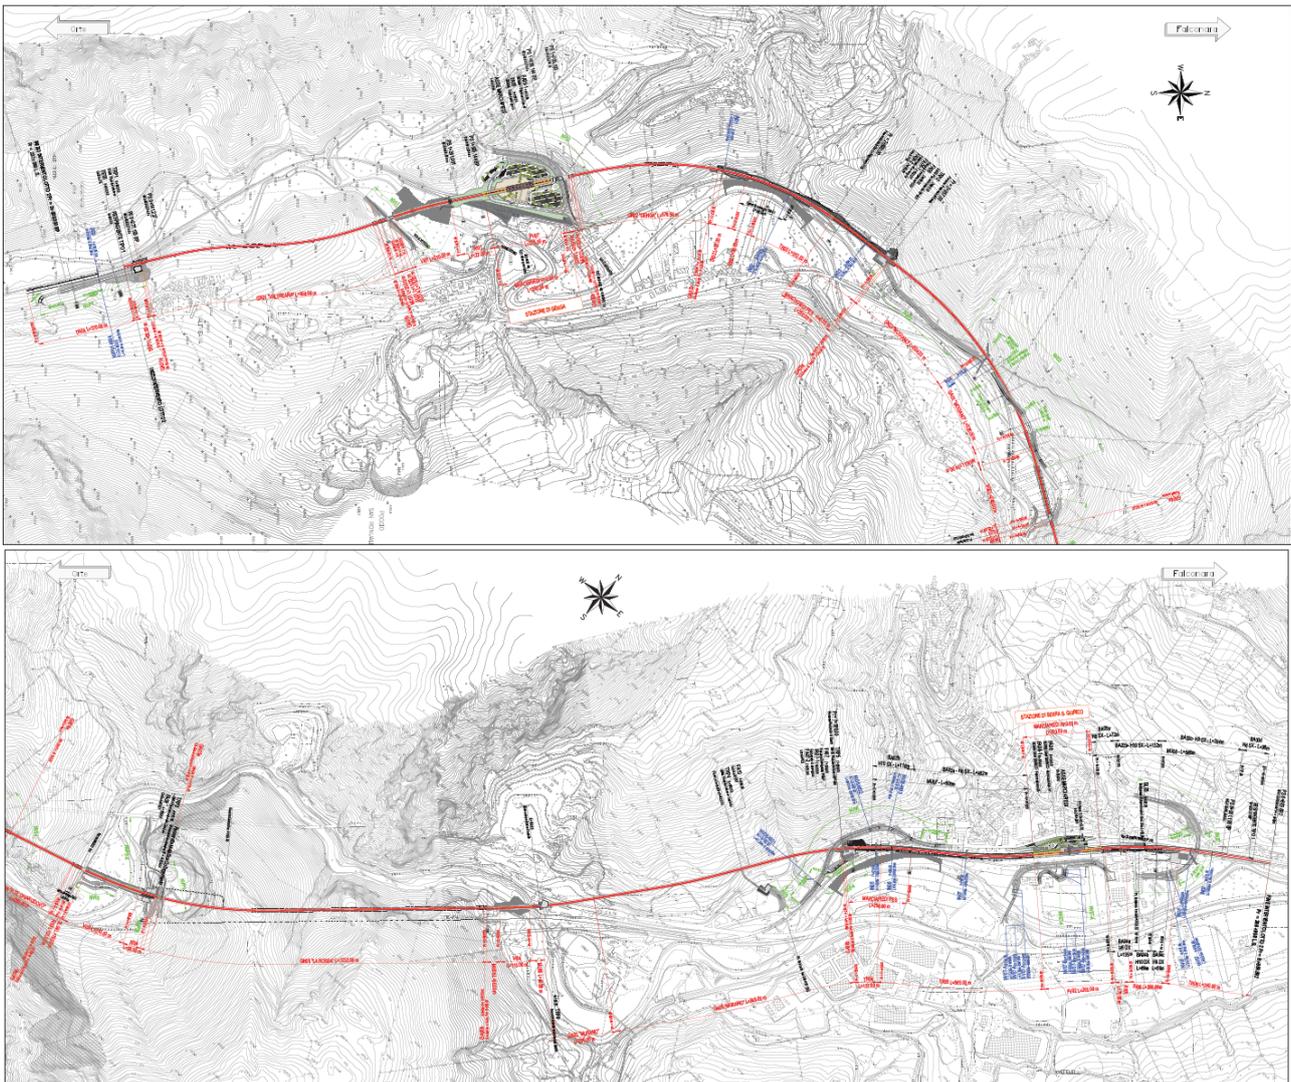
Stralcio della Tavola Planimetria con individuazione WBS - IROF02R11P51F0001101B
